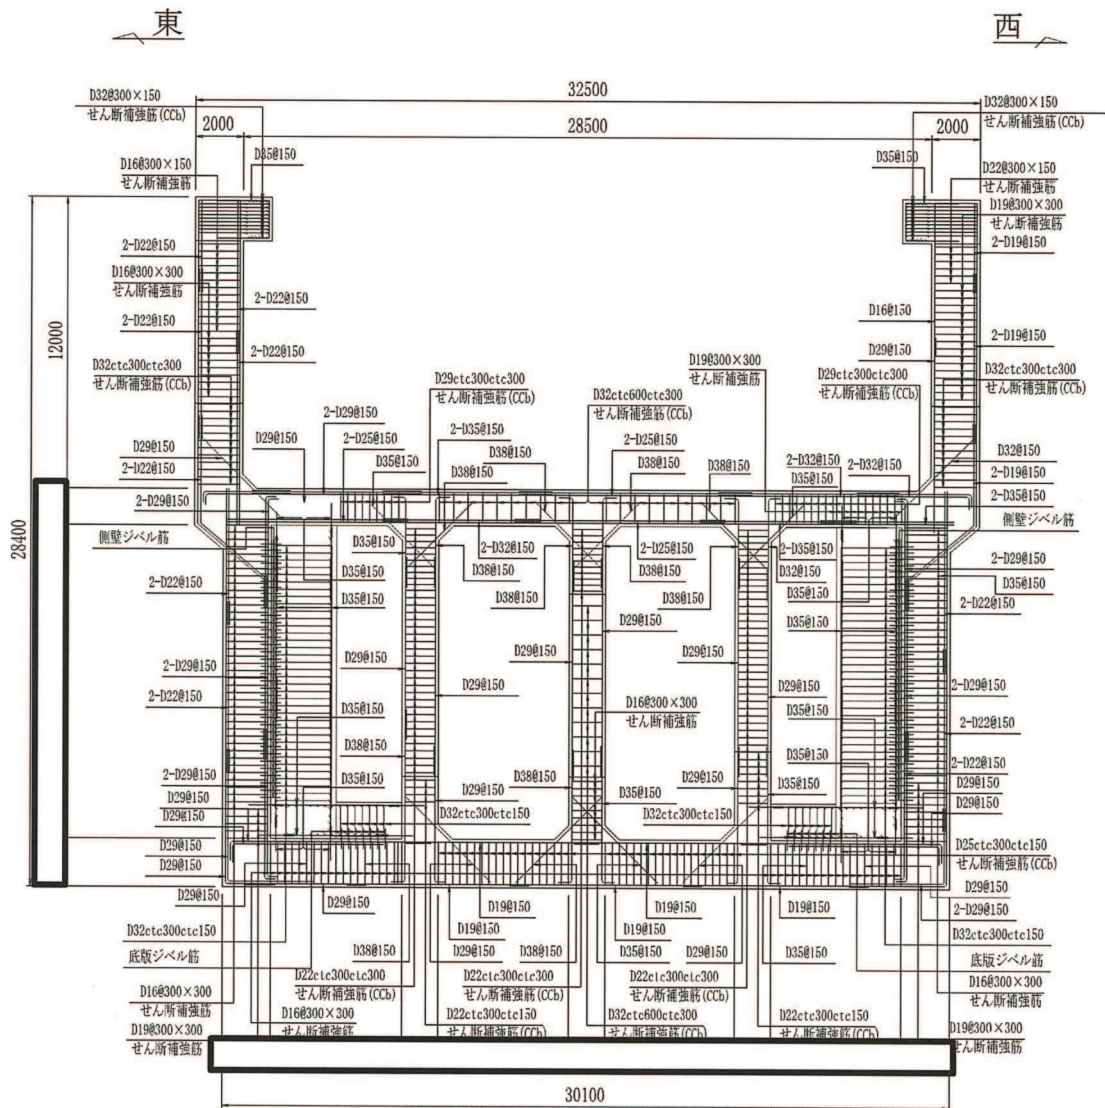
海水ポンプ室概略配筋図 (B-B 断面, 東西)
